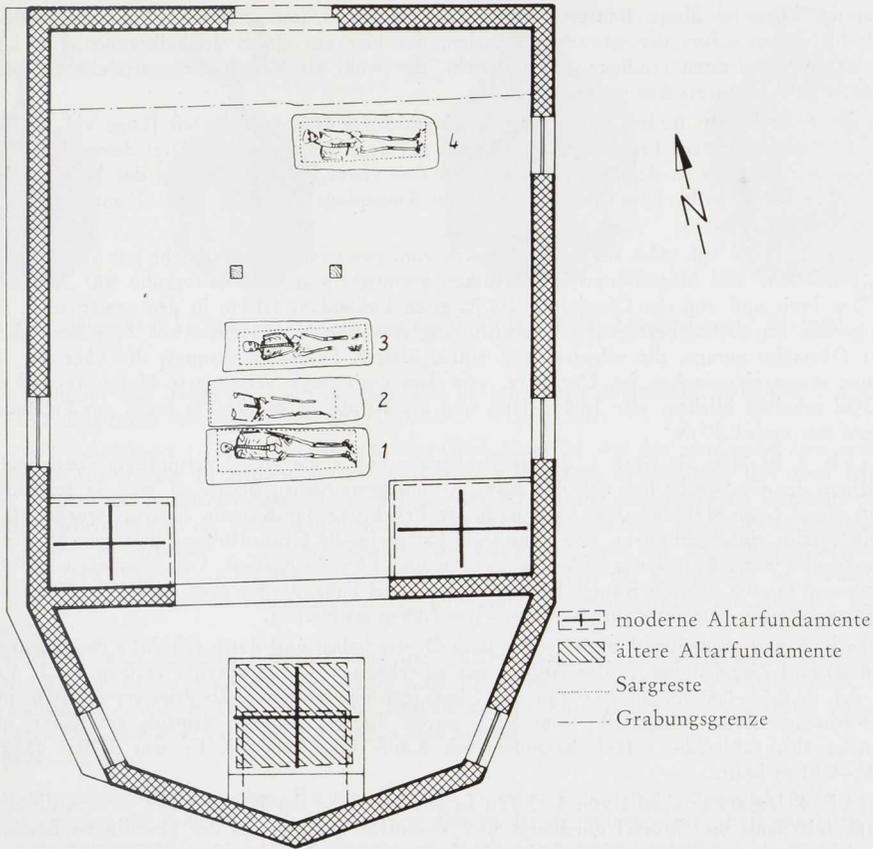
Klepsau (Lkr. Buchen). Friedhofskapelle; Grundriß mit Befunden. (Nach Bauaufnahme von BANNWARTH und KISTNER, Adelsheim.) Maßstab 1 : 200.
